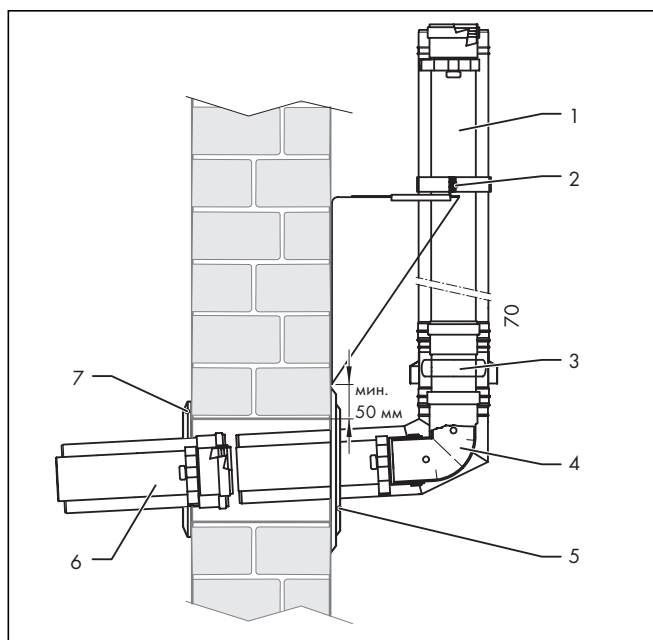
Монтаж подключения для прокладки по наружной стене
